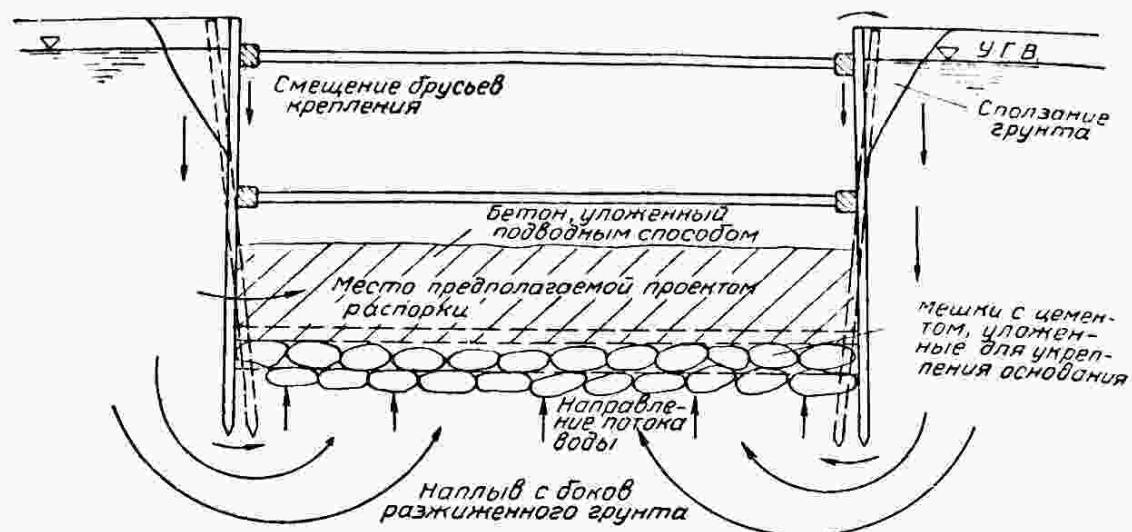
Устройство фундамента моста на оросительном канале в Египте
